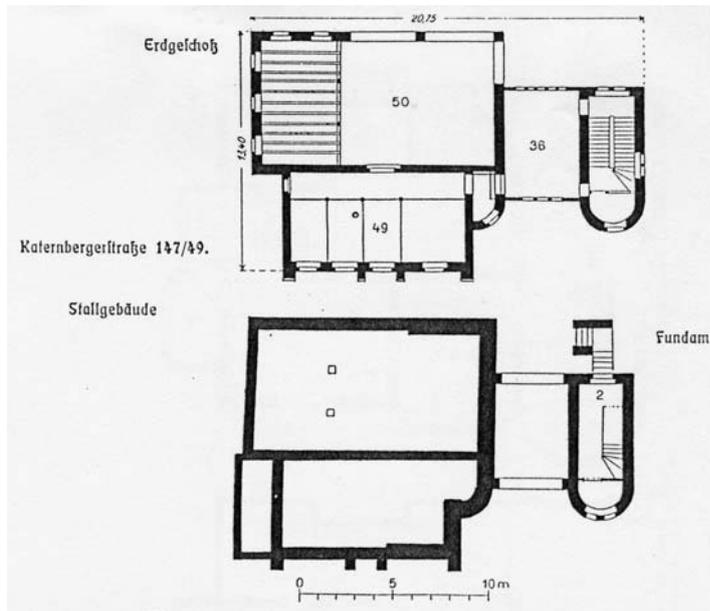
Kutscherhaus und Pferdestallgebäude , Grundriss Erdgeschoss (oben) und Fundamente, 1913
